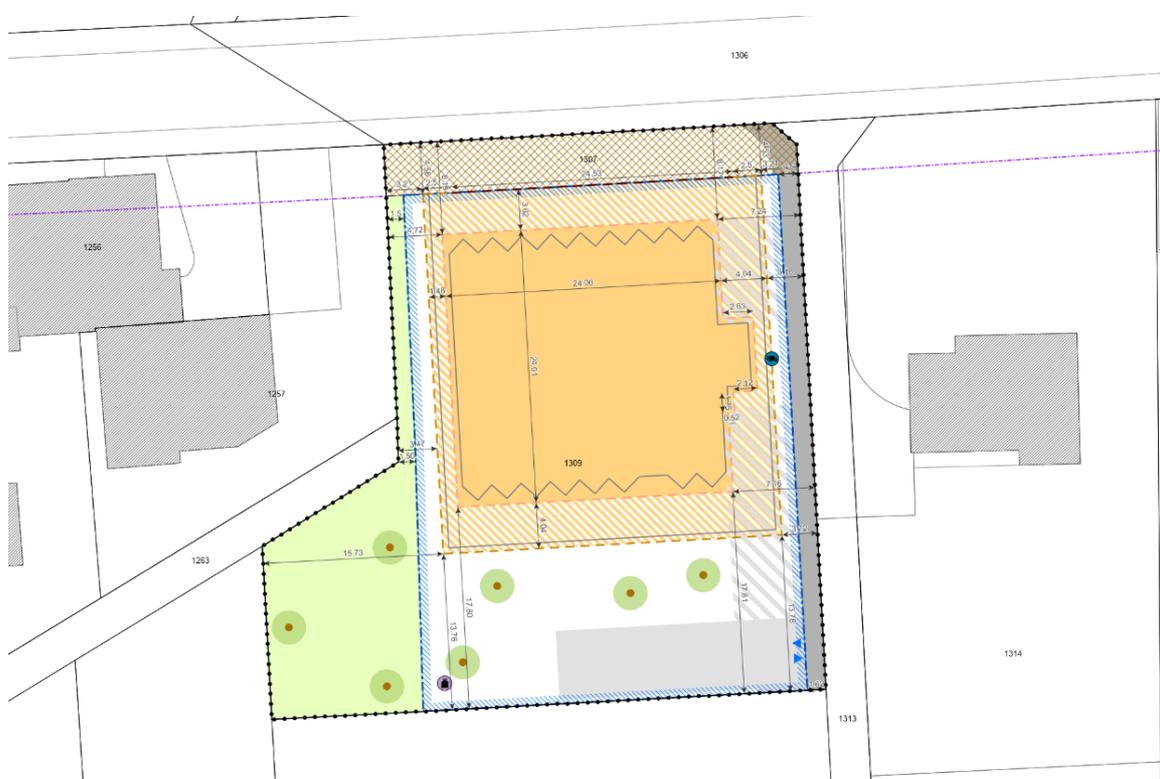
Ausschnitt Überbauungsplan (nicht massstäblich)
